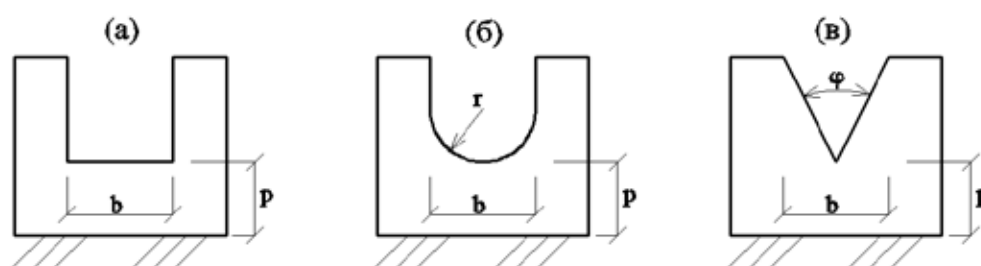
Виды поперечных сечений водослива с широким порогом: а — прямоугольное сечение, б — круглое сечение, в — треугольное сечение
